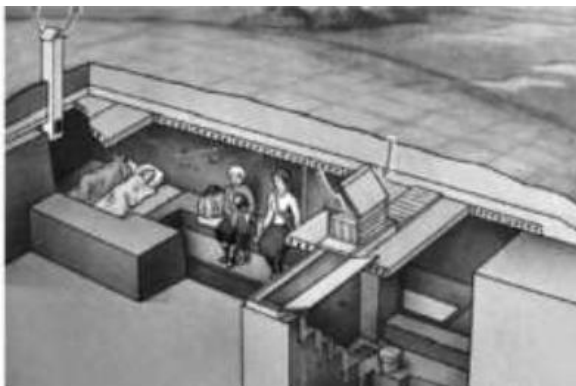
Укриття з перекриттям залізобетонними плитами.
